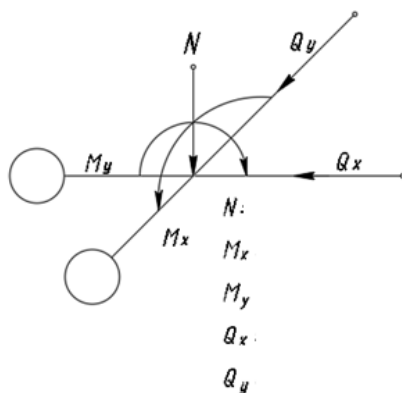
Расчетная схема усилий действующих на фундамент
